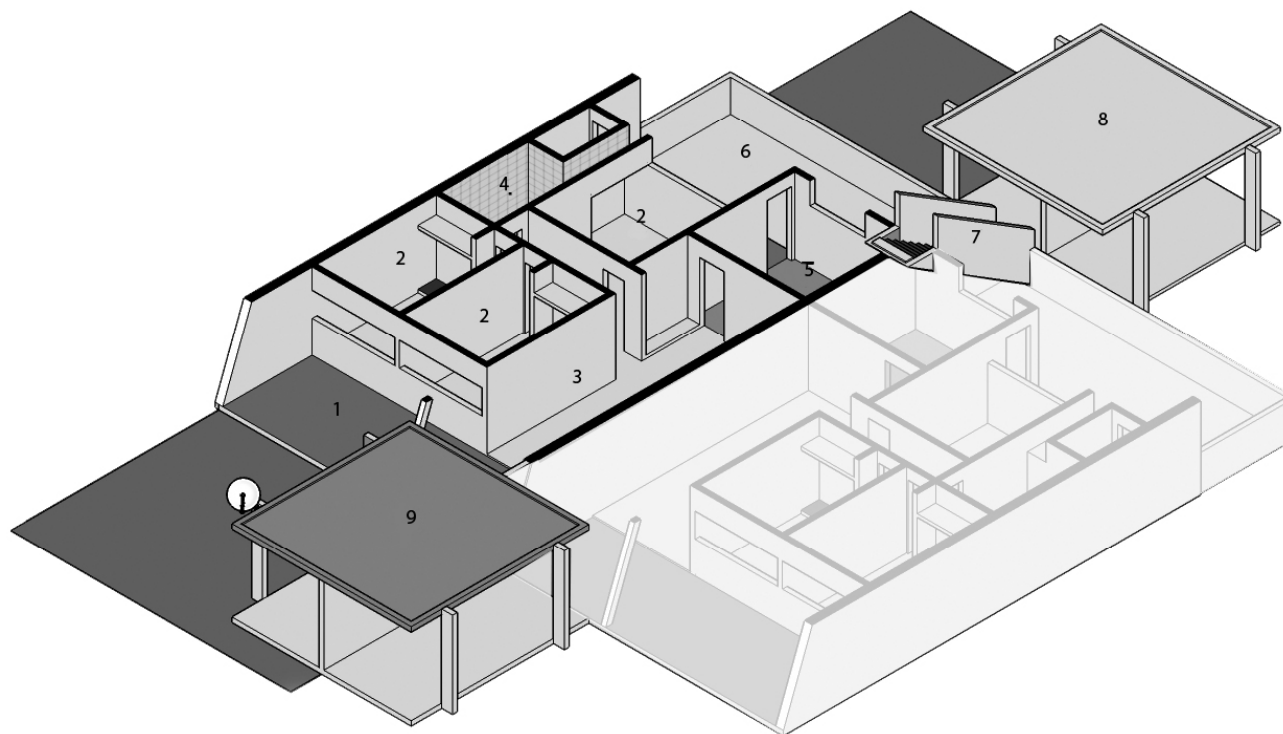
Planta baixa do H-21, unidade do pavimento térreo e do superior. Legenda: 1) Varanda, 2) Dormitório, 3) Sala, 4) Banheiro, 5) Cozinha, 6) Área de serviço, 7) Corredor de Circulação da área comum. Fonte: Autor, 2018.
